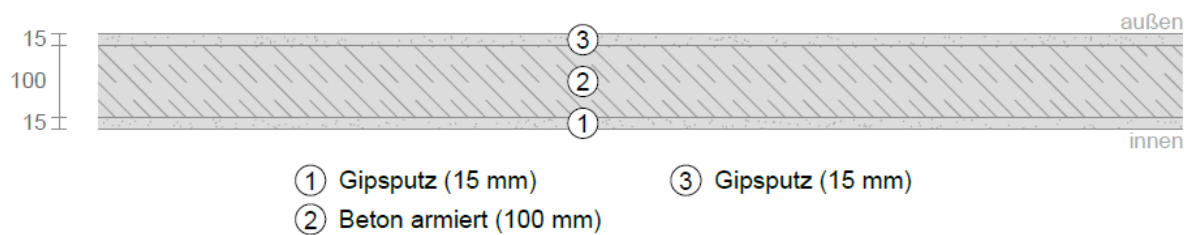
Aufbau Stahlbetonwand. Erstellt mit U-Wert.net
